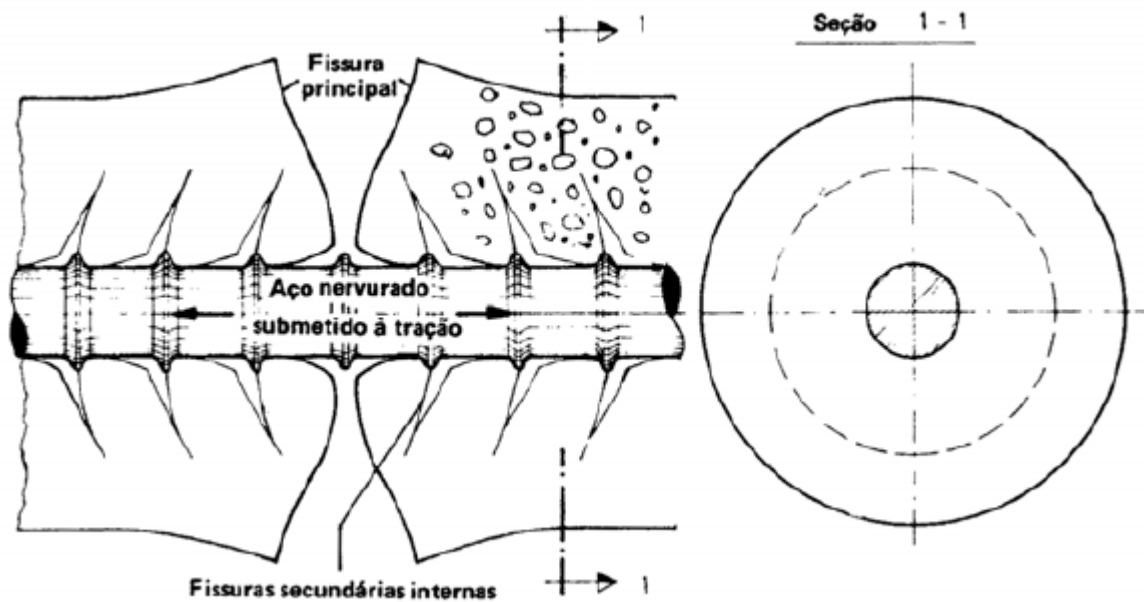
Microfissuração do concreto (GOTO, 1971)
